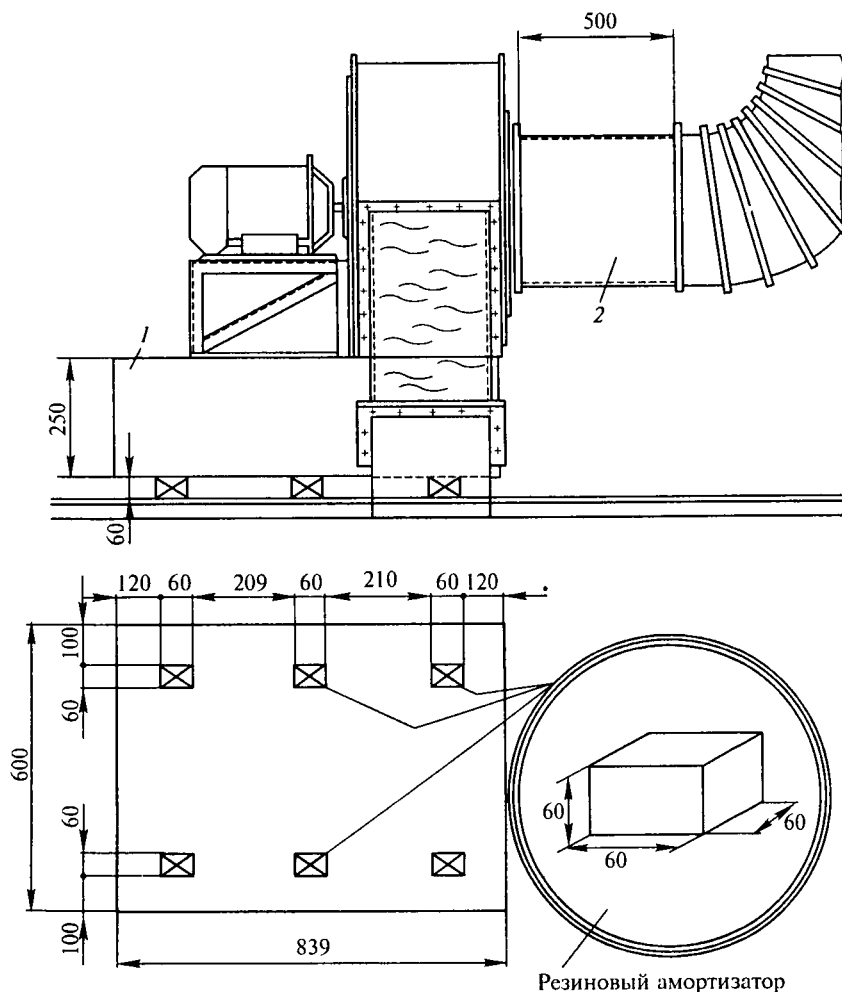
Схема установки вентилятора на плавающем основании:
